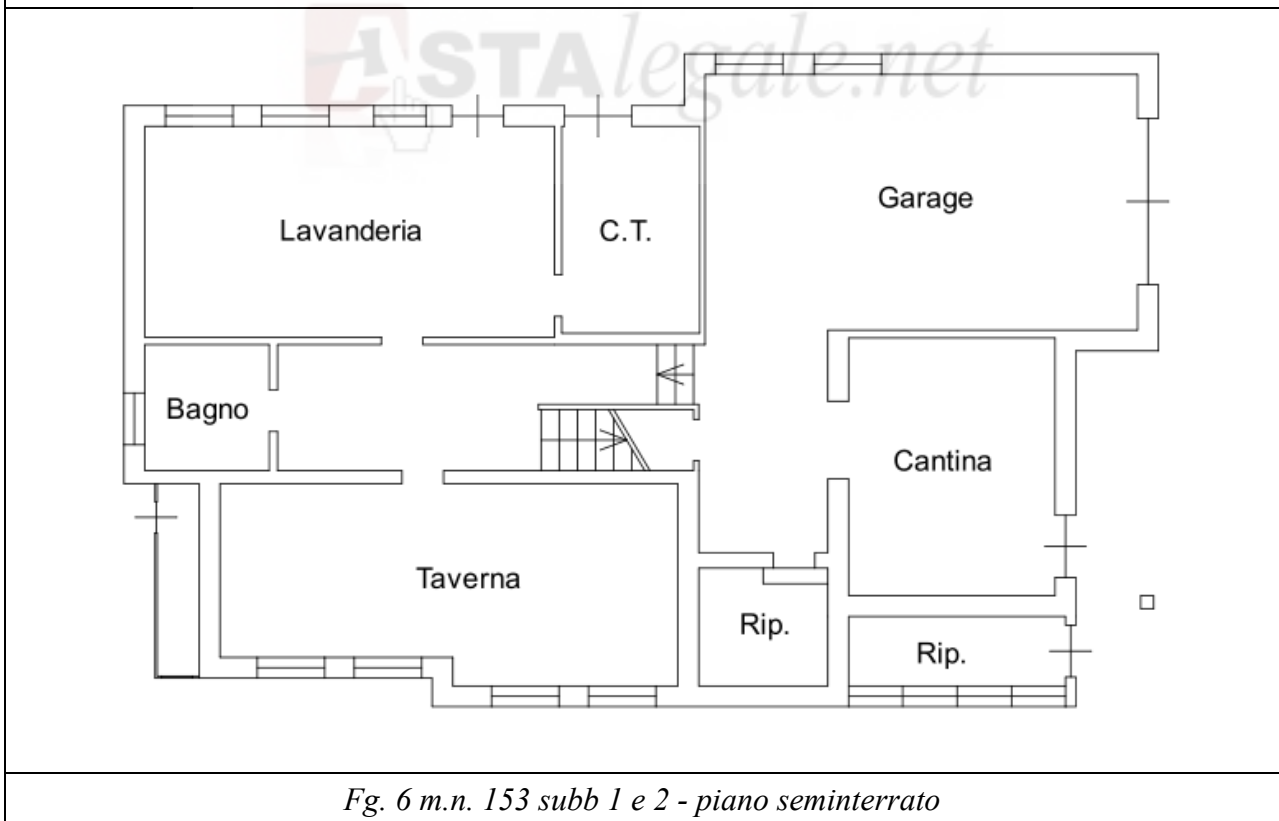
m.n. 153 subb 1 e 2 - piano seminterrato
